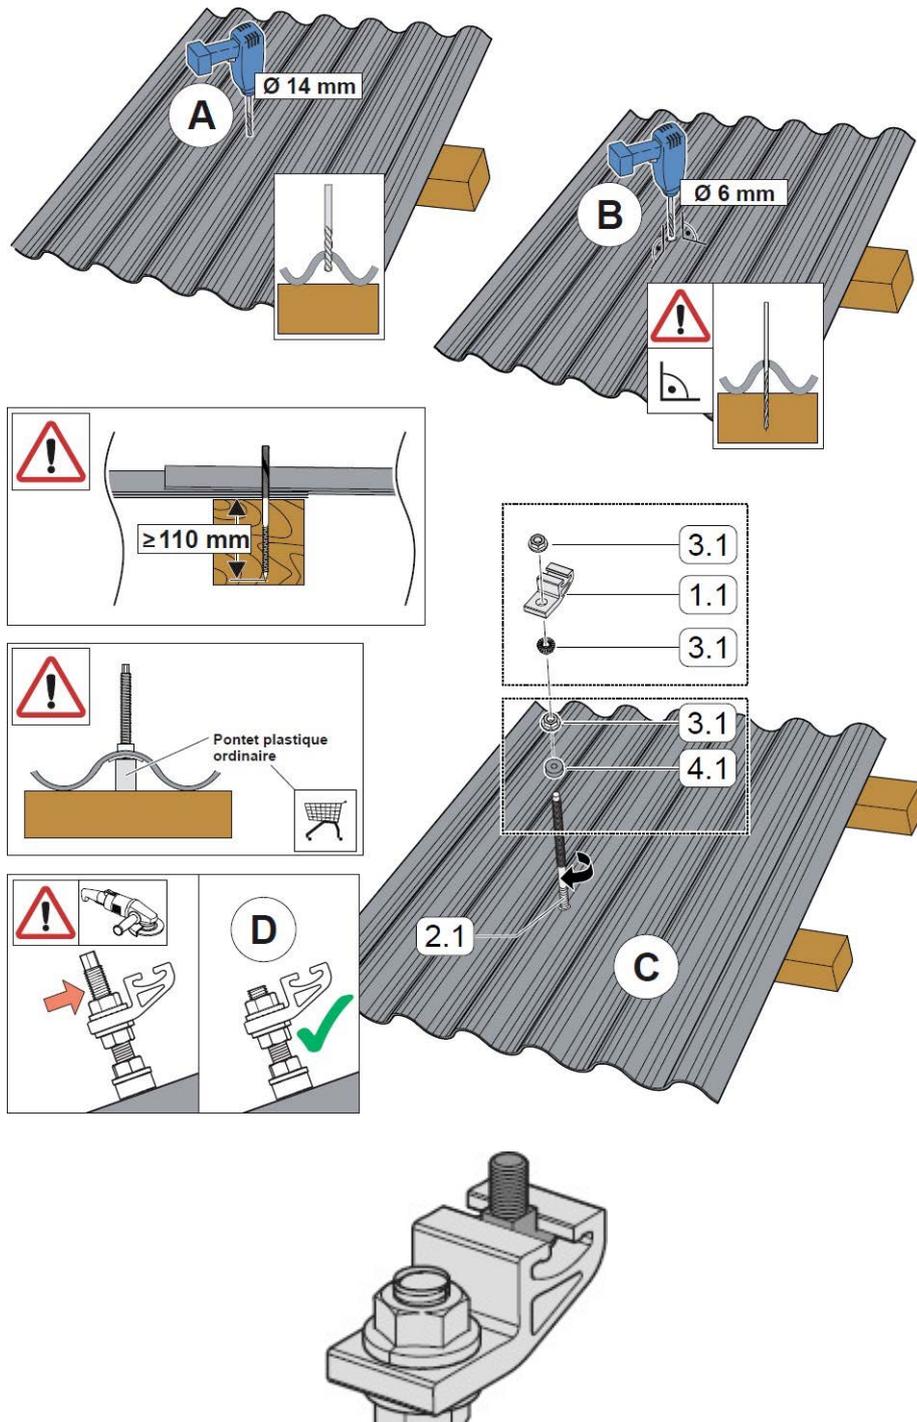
Pattes de fixation pour plaques et tôles ondulées.
